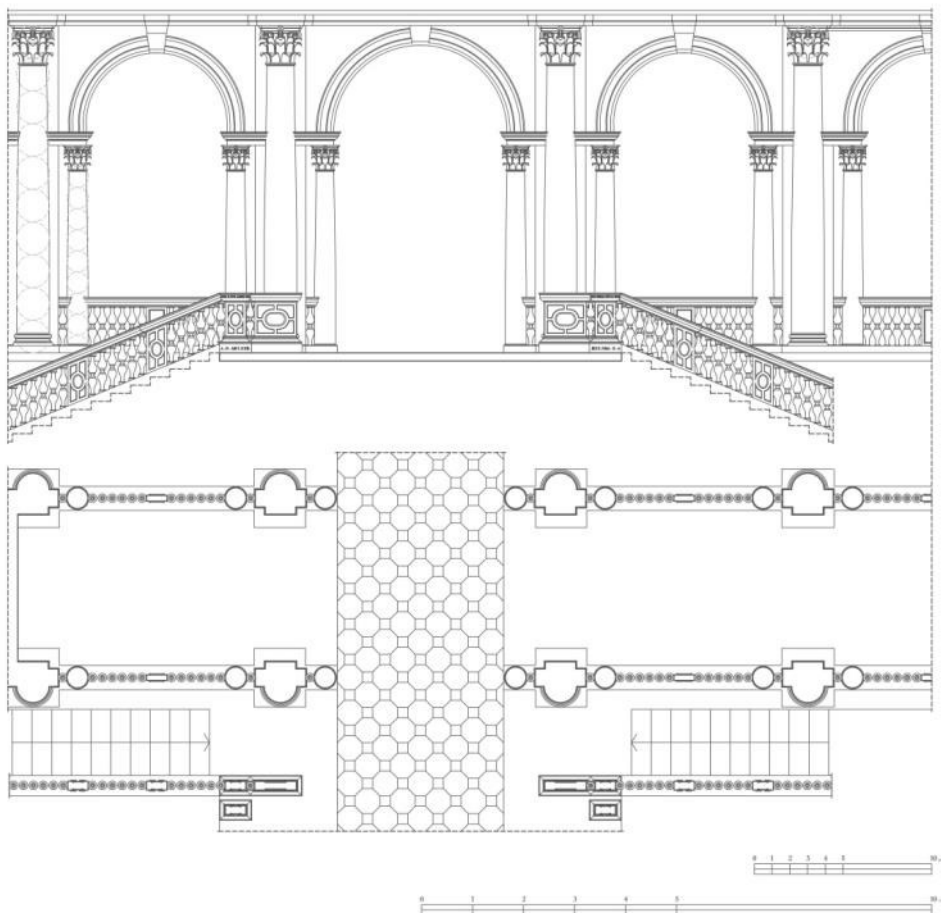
Ricostruzione della pianta e del prospetto della loggia (Elab. S. Masserano).
